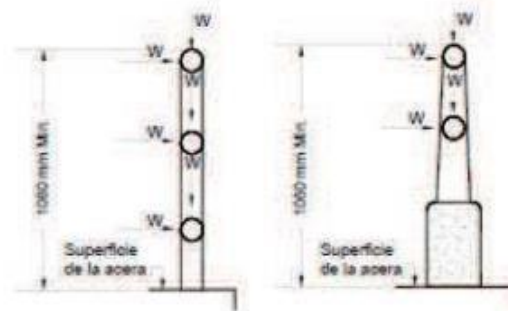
Cargas que actúan sobre las barandas para peatones. Baranda a utilizar en el borde exterior de una acera cuando el tráfico vehicular está separado del tráfico peatonal mediante una baranda para tráfico vehicular. Las geometrías de las barandas son simplemente ilustrativas (Fig. 13.8.2-1 AASHTO)
